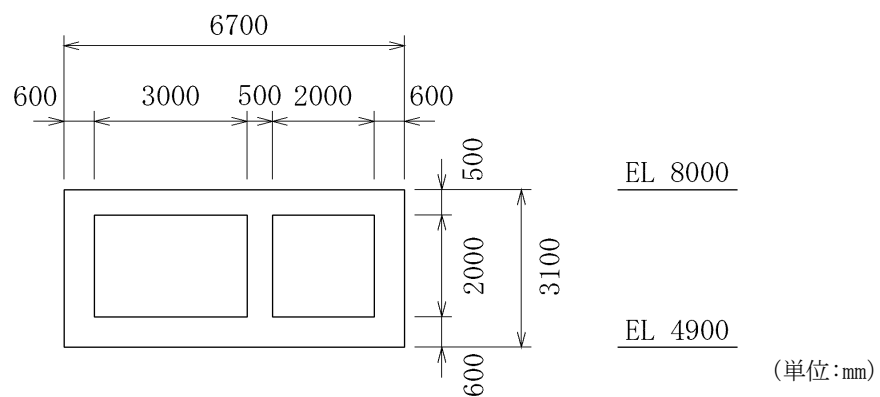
屋外配管ダクト (タービン建物～排気筒) 断面図 (A-A断面)
